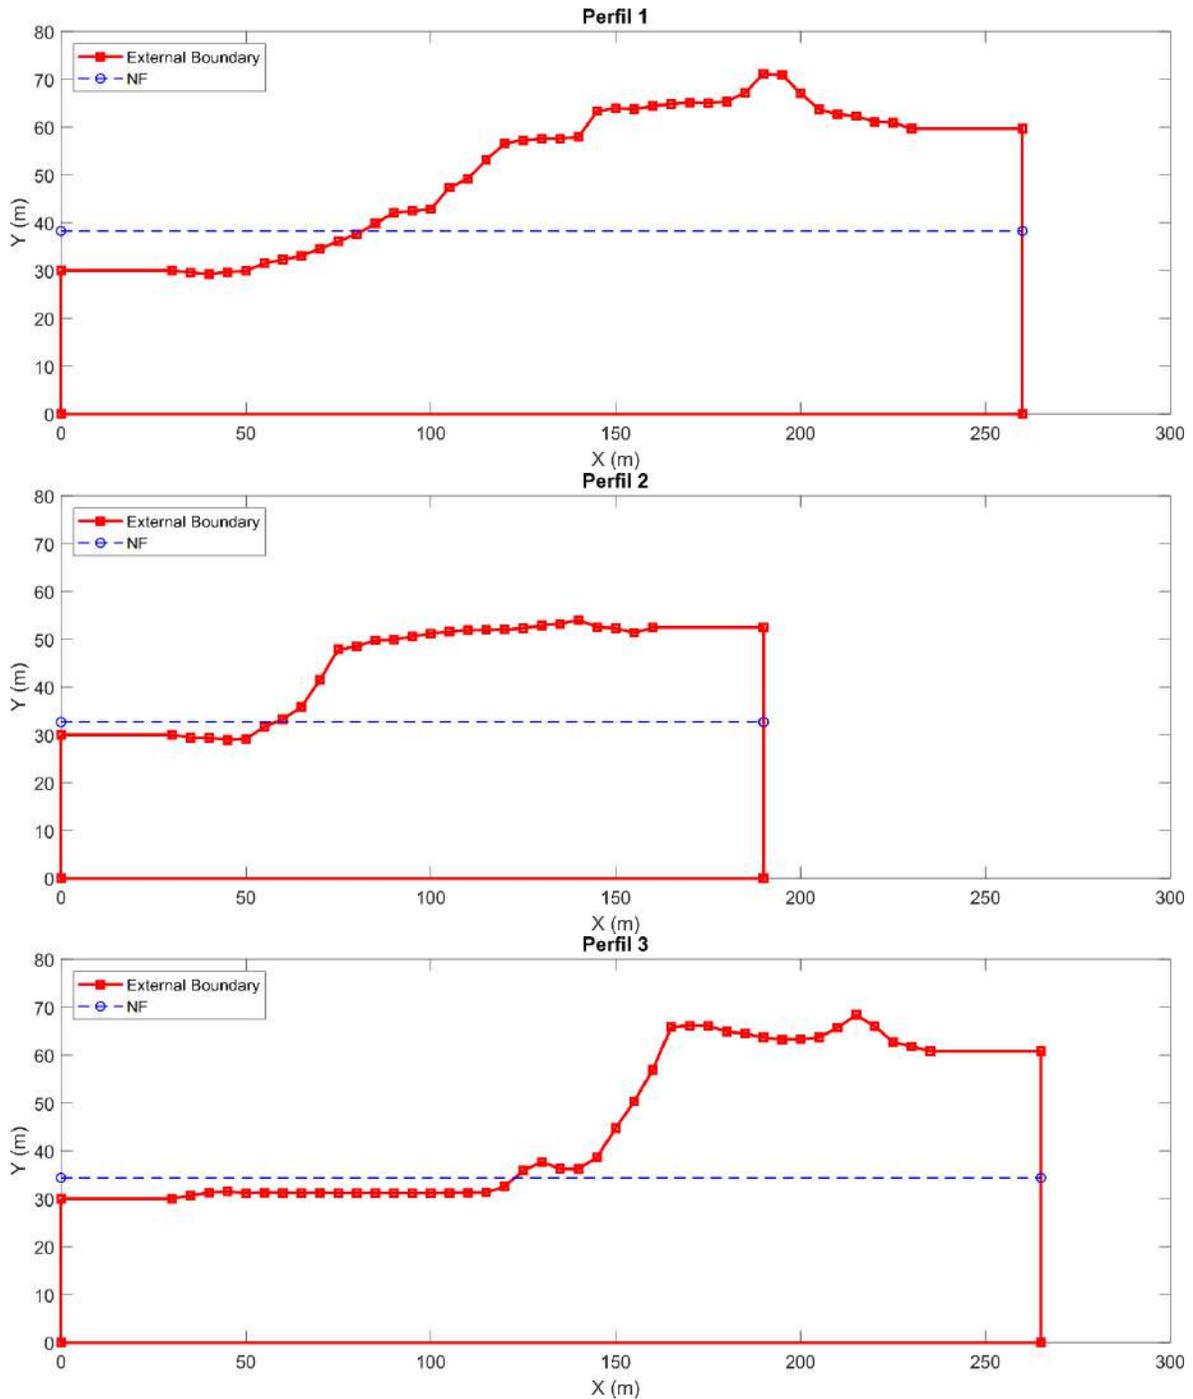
Corte transversal de perfiles considerado en el análisis de estabilidad para condición actual, en rojo se destaca la geometría de la sección, para Perfil 1 (superior), Perfil 2 (centro) y Perfil 3 (inferior).
